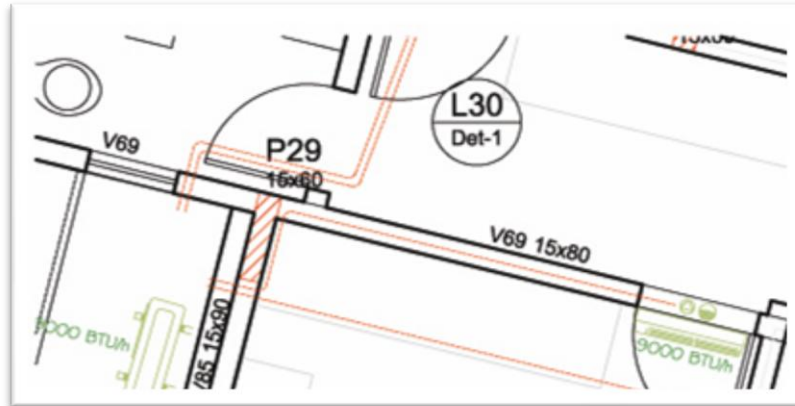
Planta baixa intersecção dutos com vigas.
